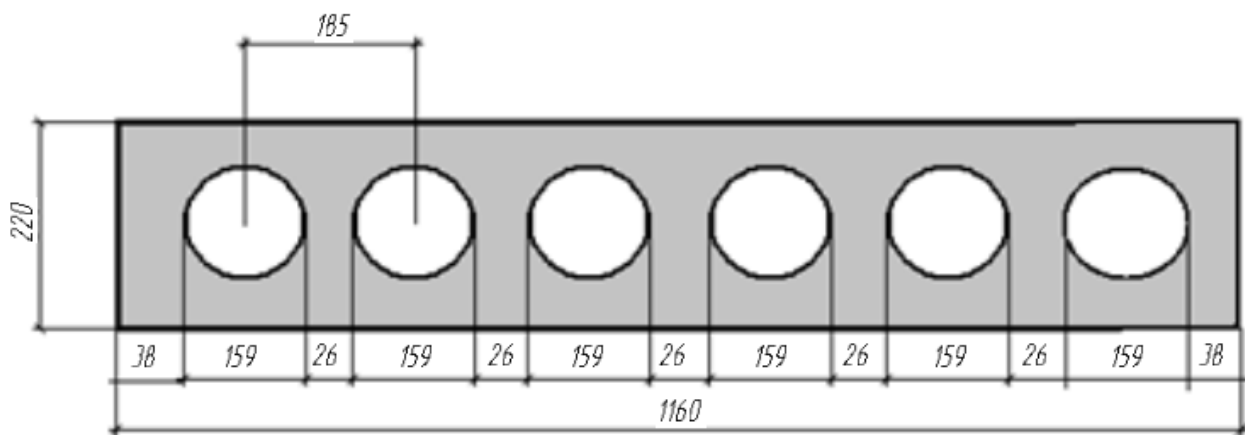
Конструктивные размеры железобетонной многопустотной плиты
